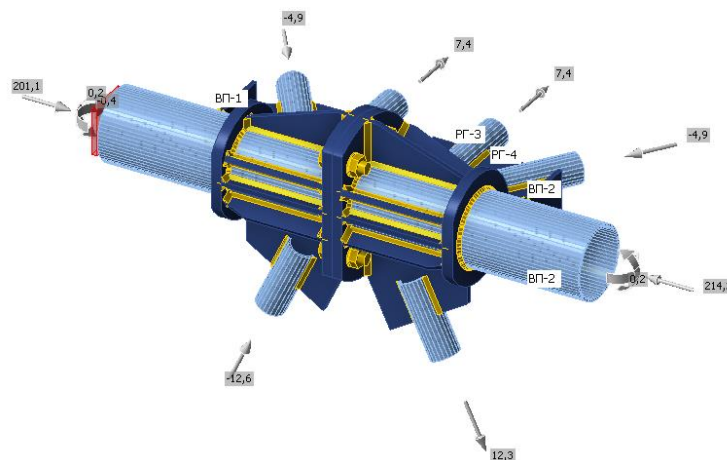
Монтажний стик верхнього поясу просторового блоку ферми
